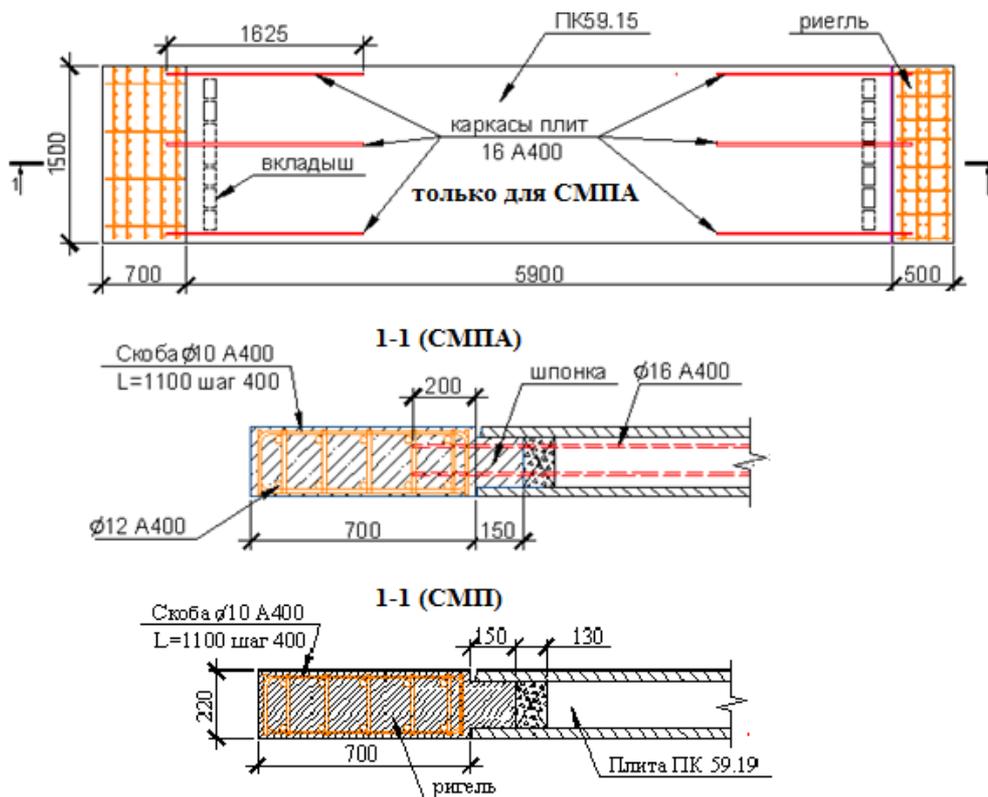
Образец с выпусками продольной арматуры каркасов многопустотной плиты (СМПА)
